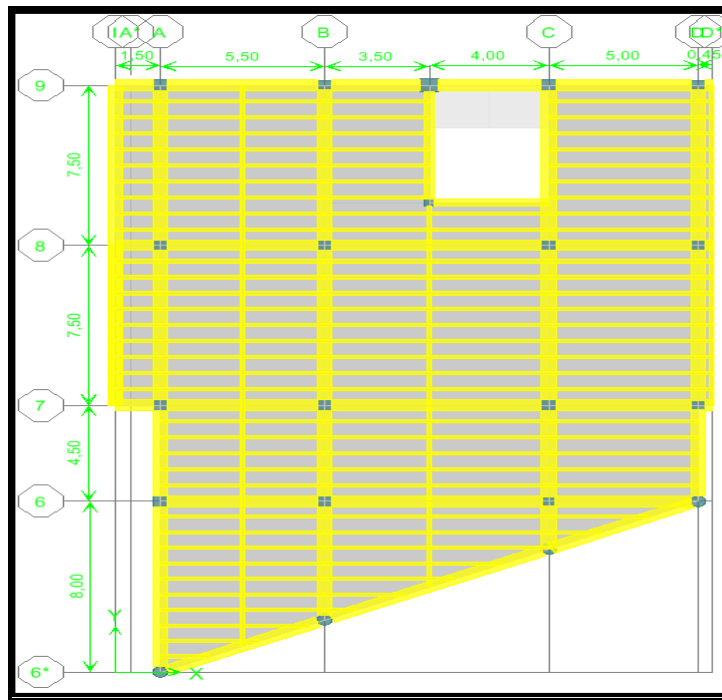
Planta de nueva configuración Módulo 2 (Edificio Sur-Oeste)
